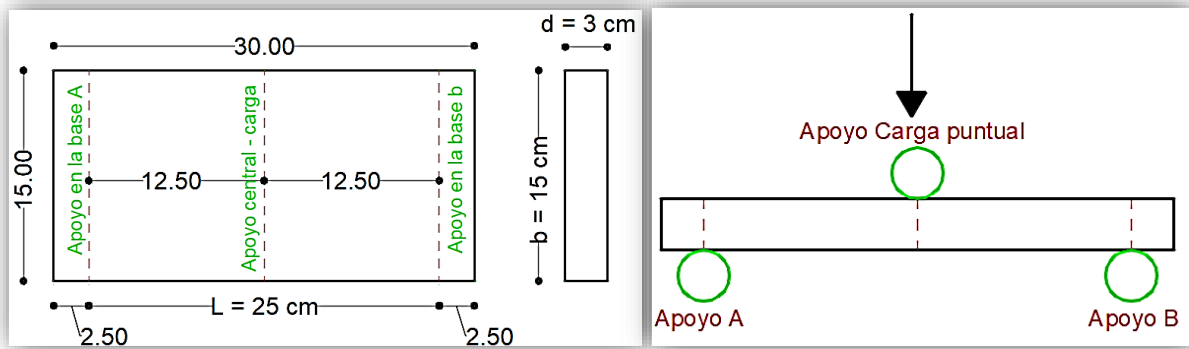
Vista en Planta y Frontal - Ubicación de los apoyos en la placa
